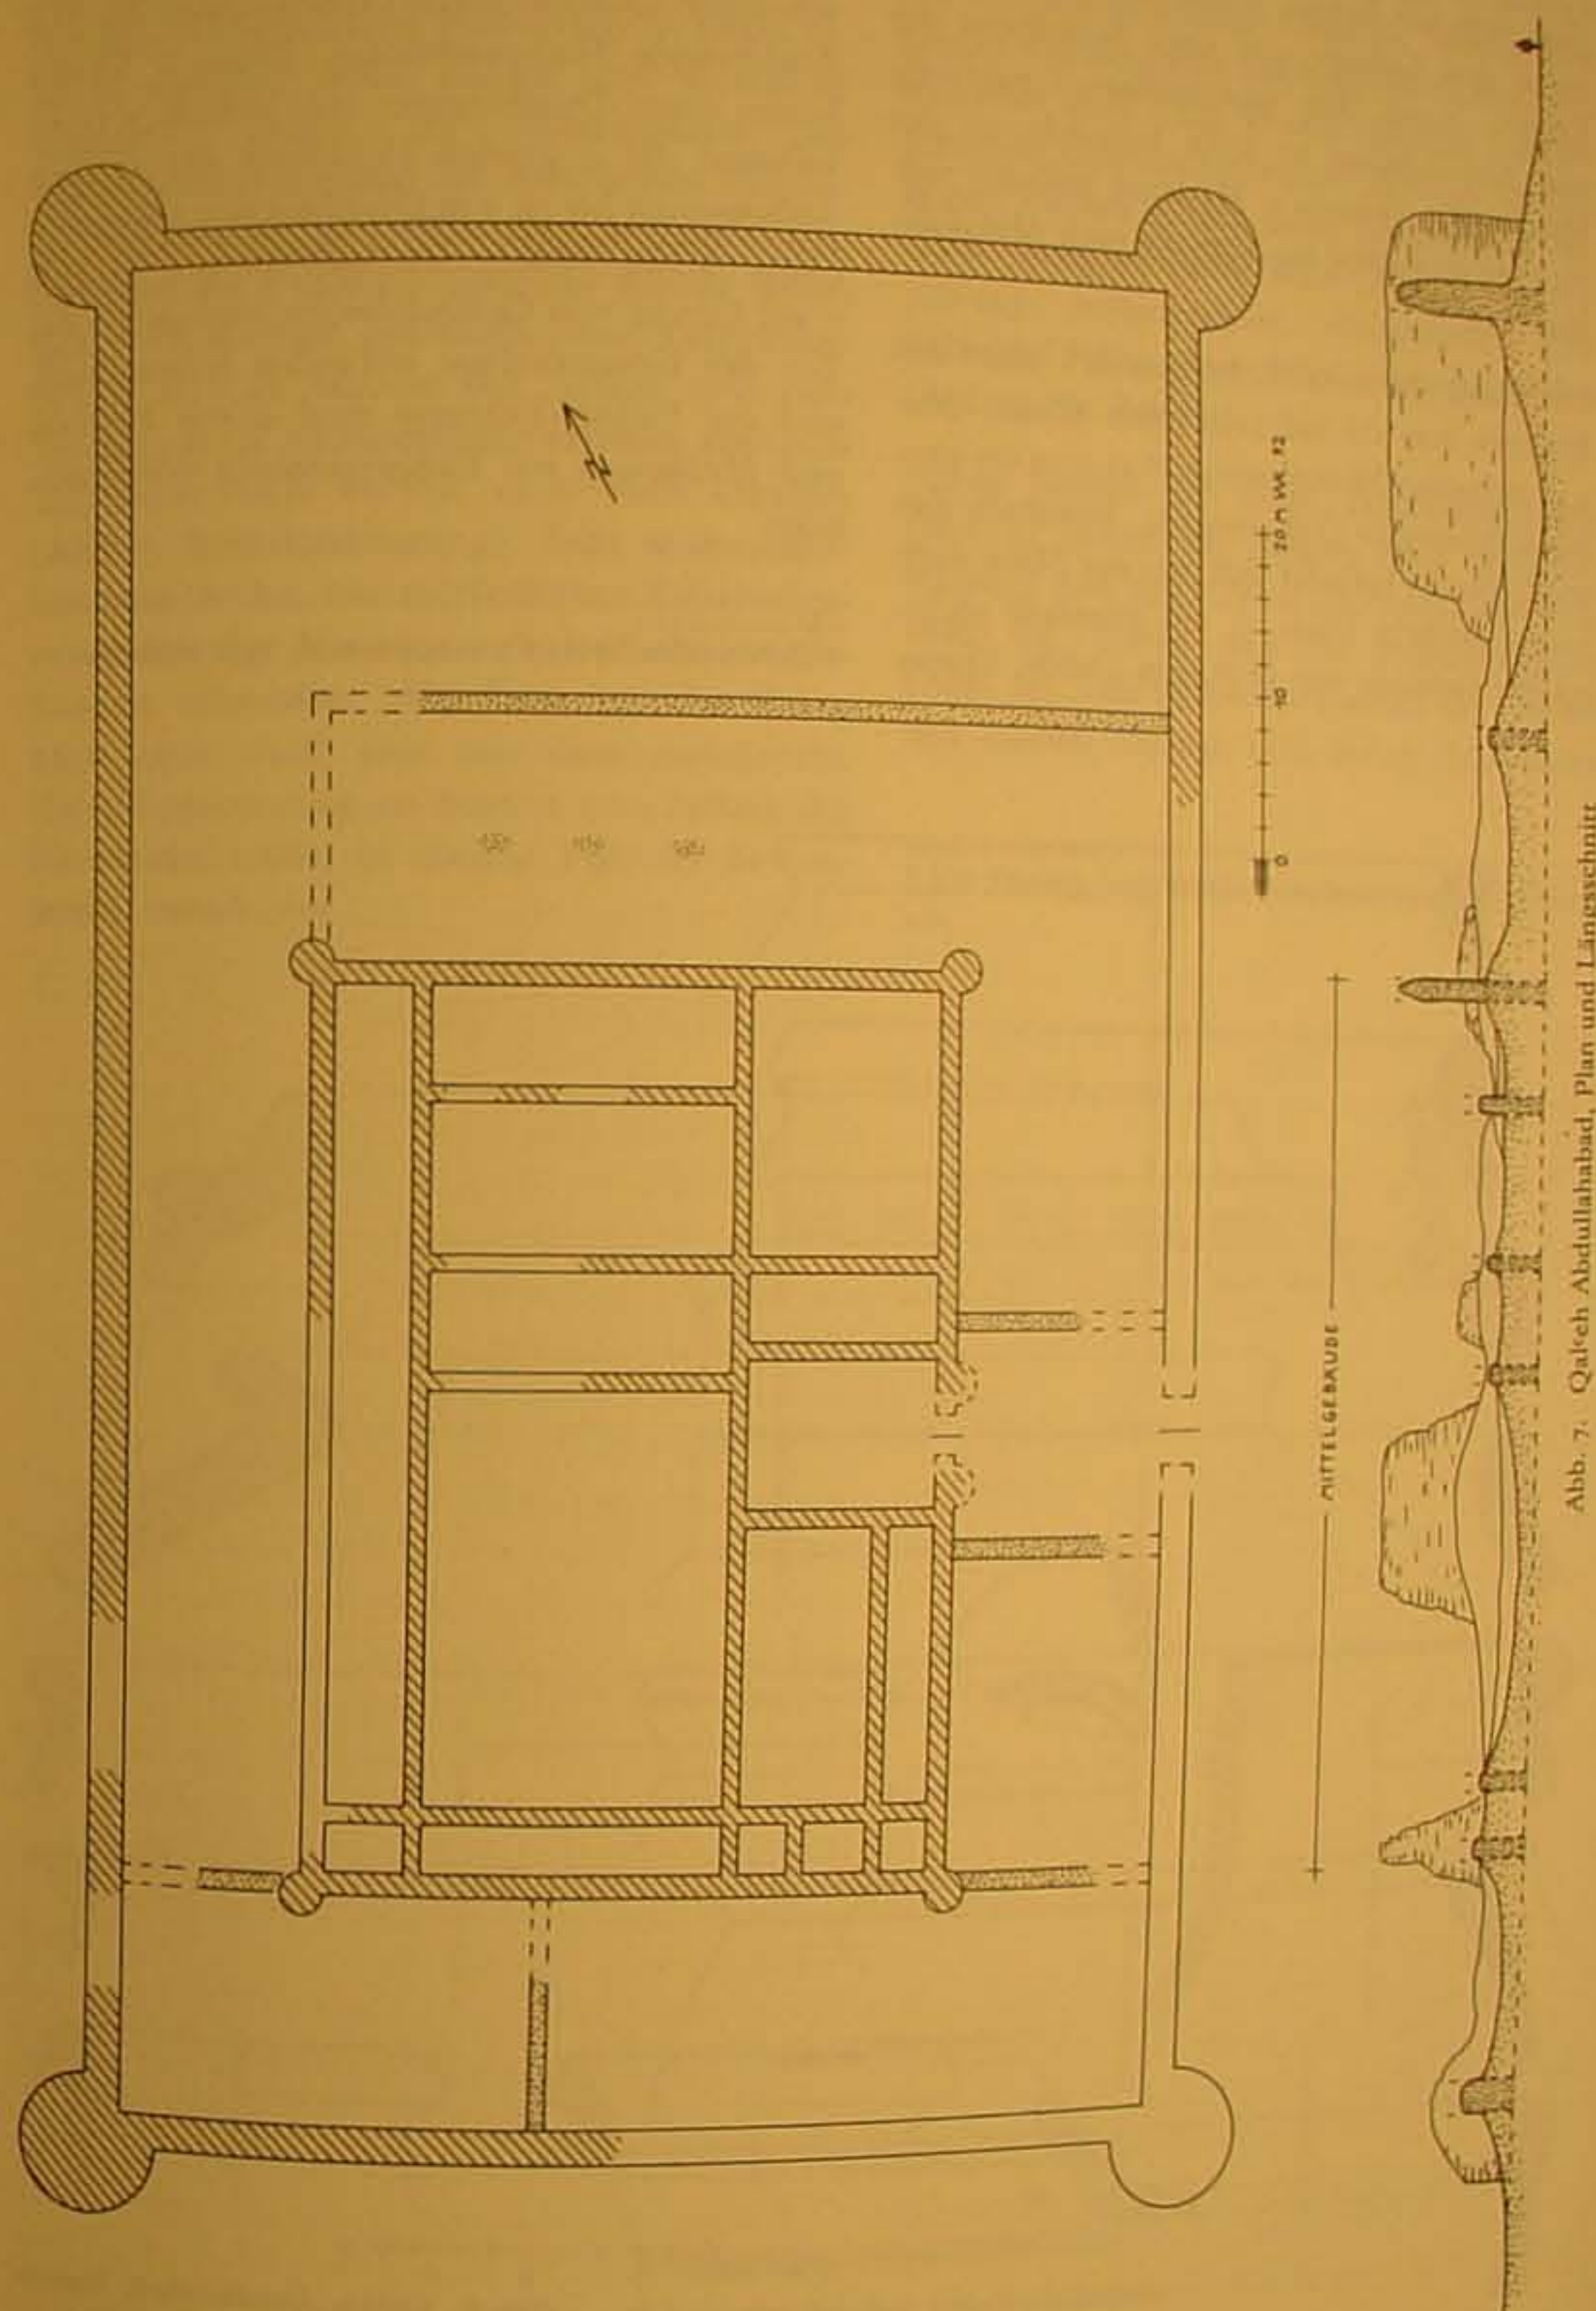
Qaleh Abdullahabad, Plan und Längsschnitt
